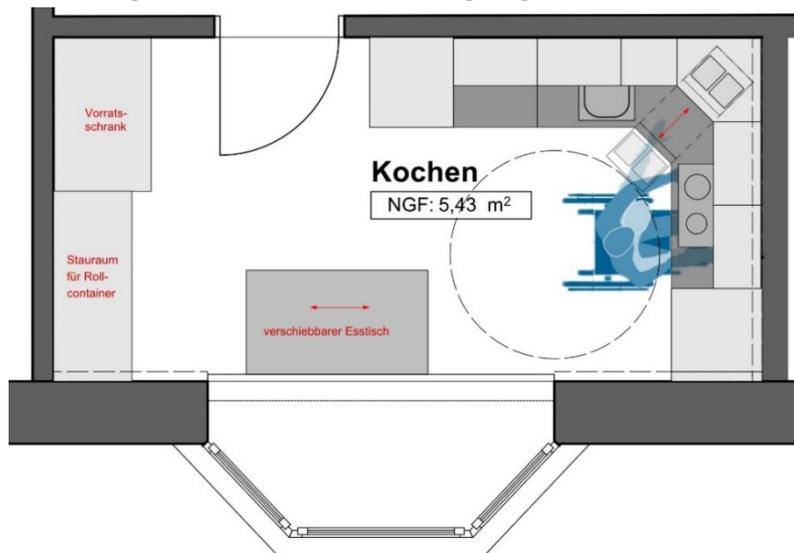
Entwurfsplanung Grundriss gelbe Küche
